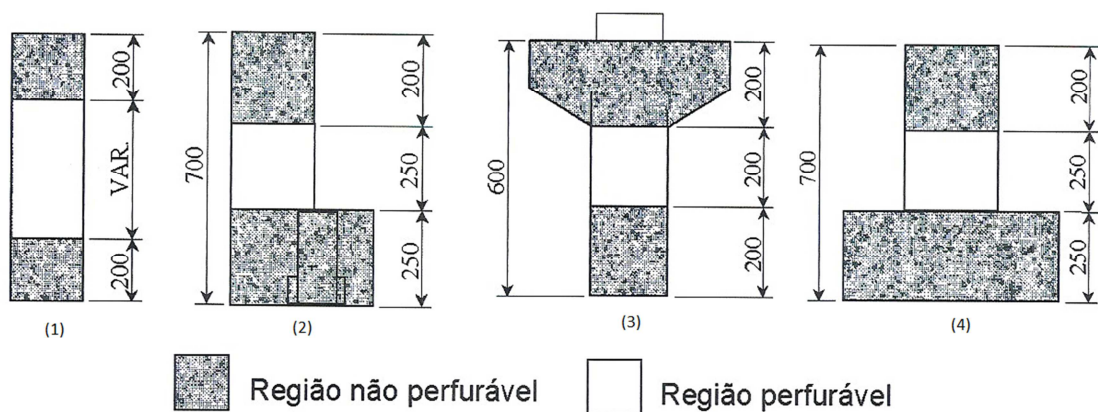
Indicação de furos em vigas pré-moldadas I e T
